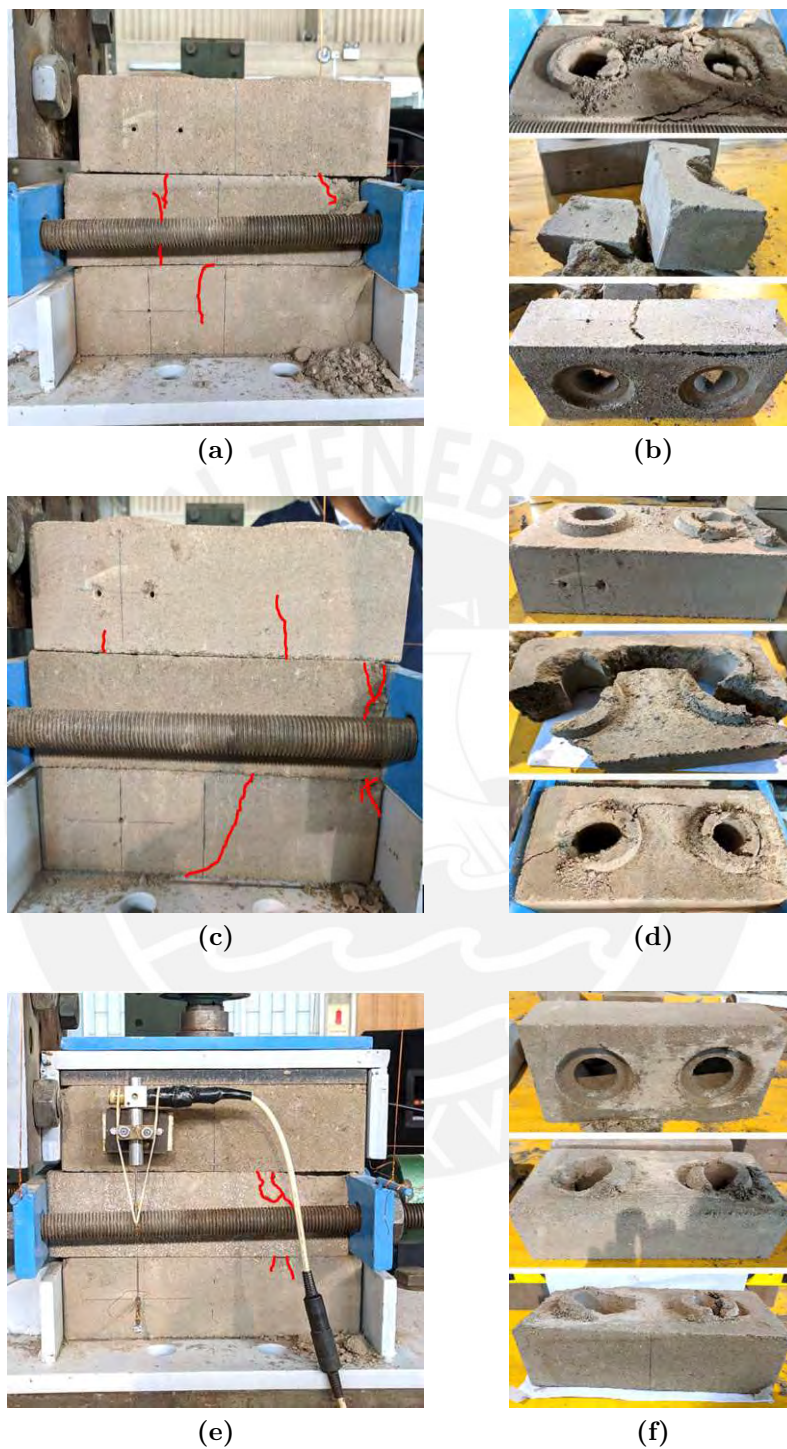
Patrones de falla en pila PCL bajo un esfuerzo de precompresión de 0.30 MPa: (a-c-e) grietas en la vista frontal de la pila y (b-d-f) fallas generadas en las unidades.
